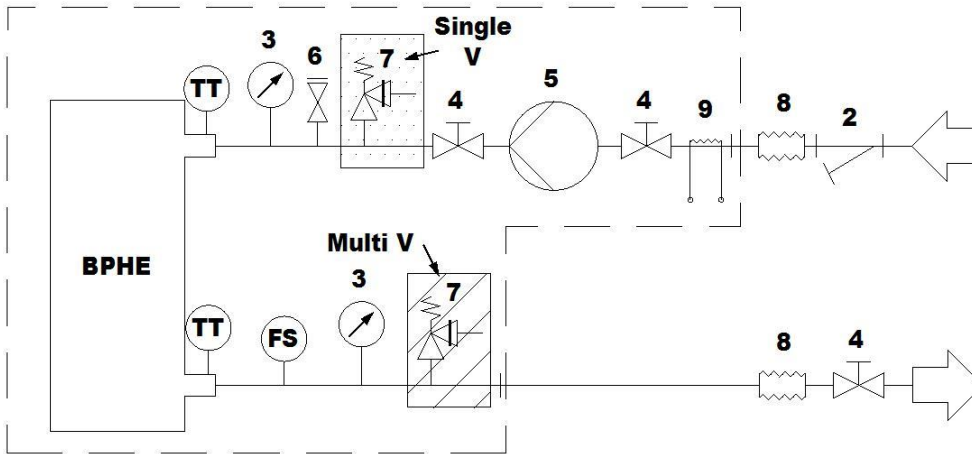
Hydraulikschemata mit eingebauter Pumpe(n) (opt. 78÷81) (max. Betriebsdruck 6 bar)
